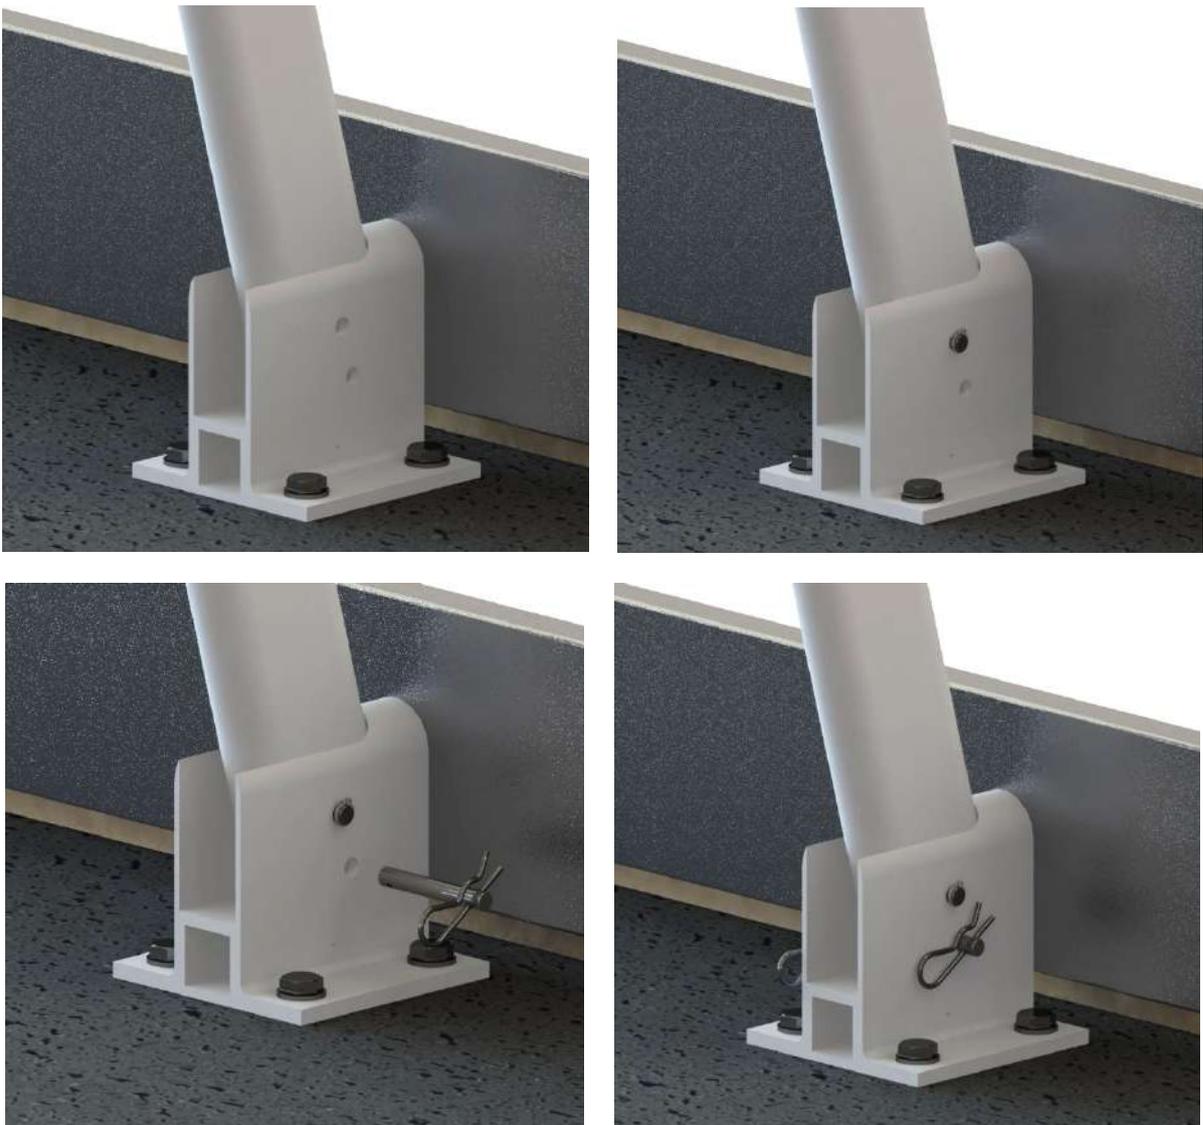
Instalación del montante en el piede montante para parapeto abatible a suelo.
